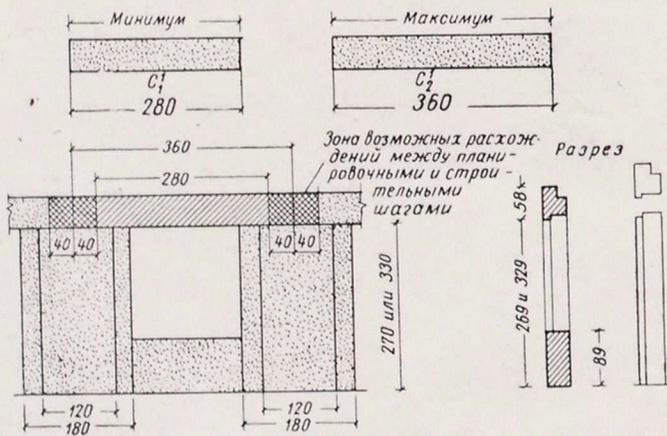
Зона возможных расхождений между планировочными и строительными шагами. Поясные блоки
